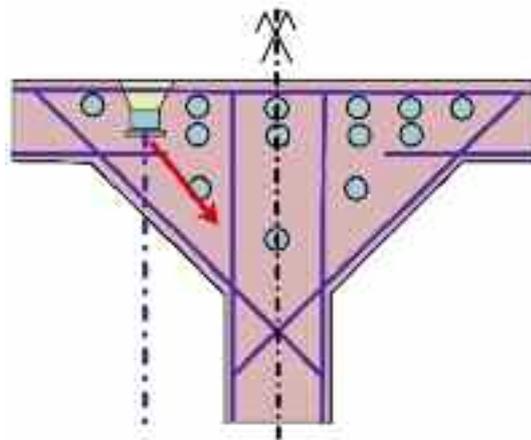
la bielle comprimée doit être équilibrée par un tirant
